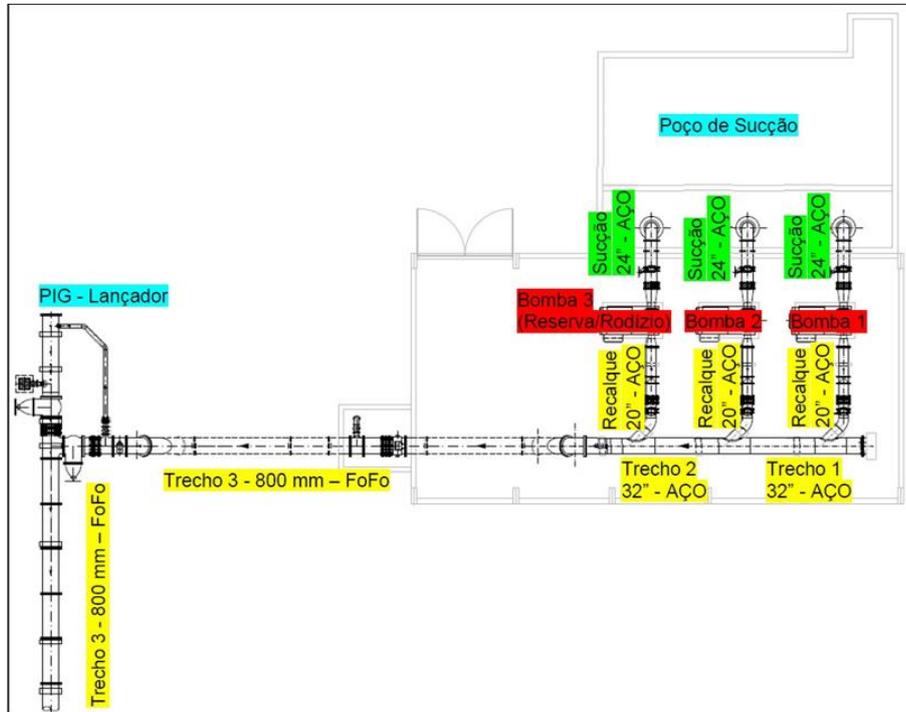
Planta da EAB3. Fonte: Arcadis (2022)
